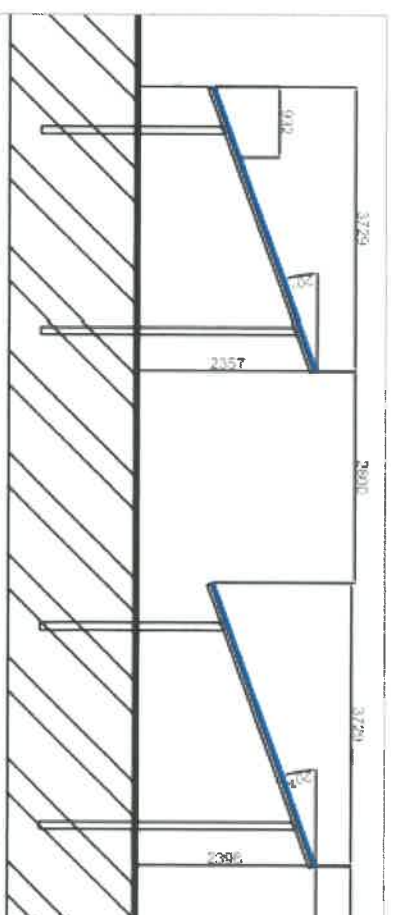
Schéma de l'agencement des tables d'assemblage (source : Serfim ENR)
